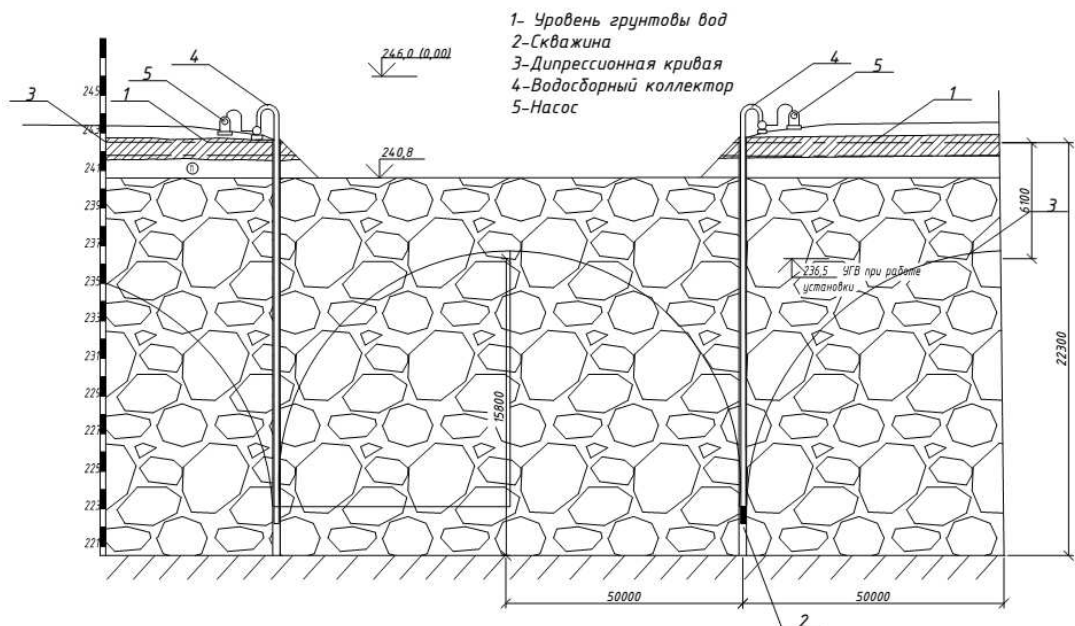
Схема контурной водопонизительной установки при ее работе в безнапорных водах:
